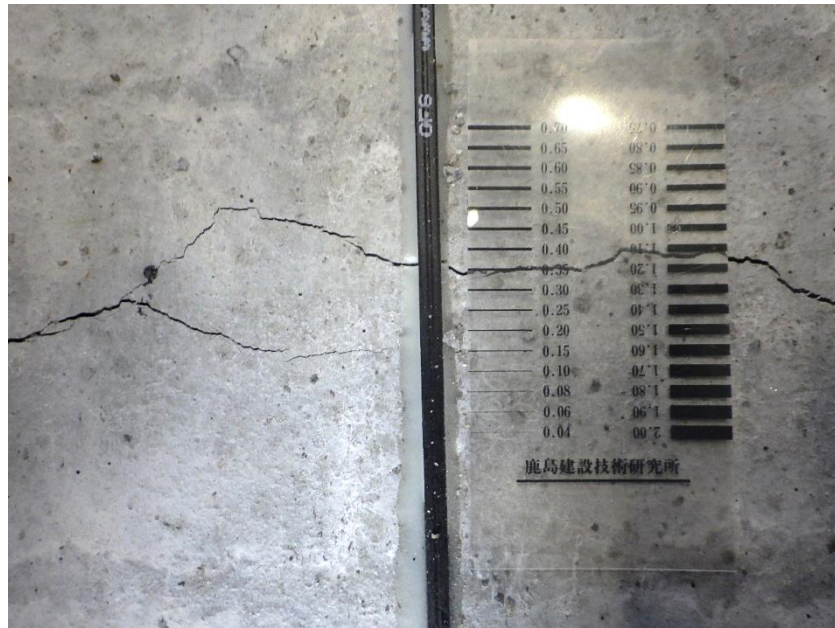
ひび割れ発生状況 (0.35mm)
